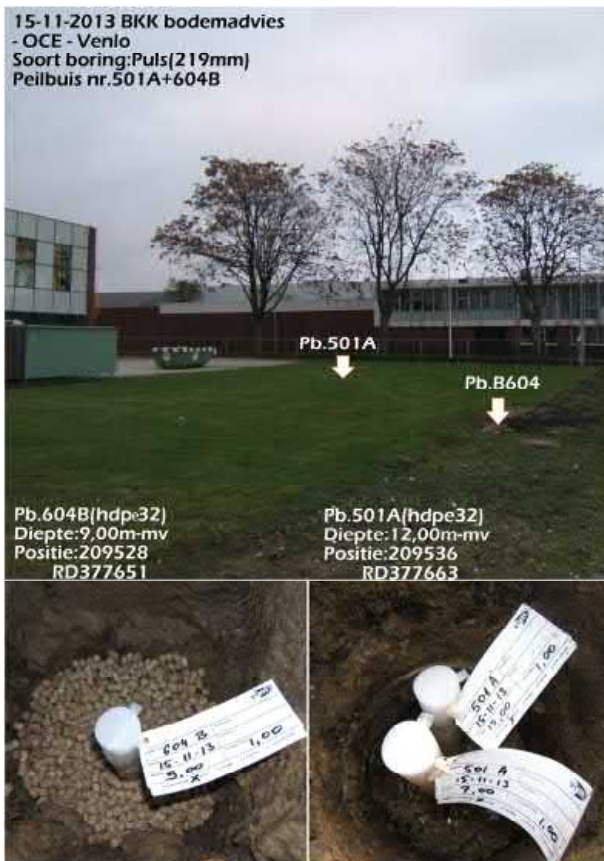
Plaatsing peilbuis 501A en 604B bij Complex 1
